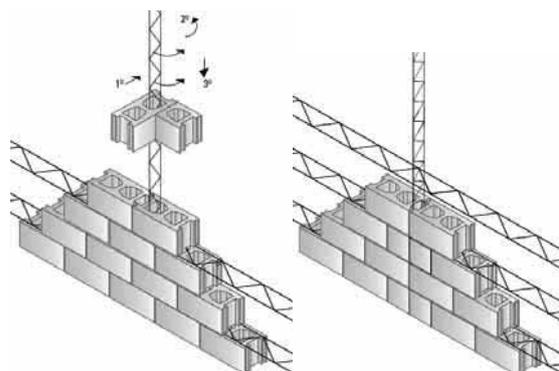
Muro acostillado trabado [derecha] y muro acostillado aparejado [izquierda].
